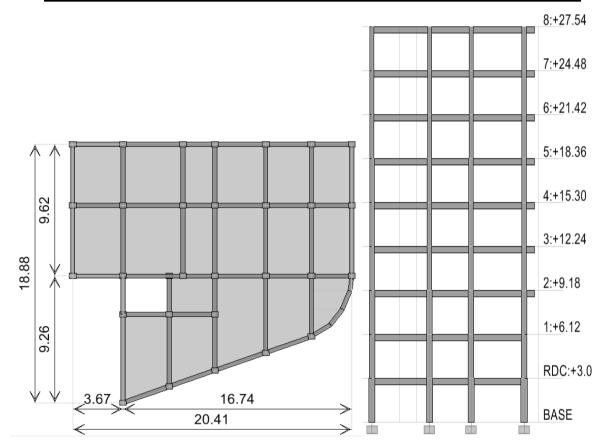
Caractéristiques géométriques en plan et en élévation
